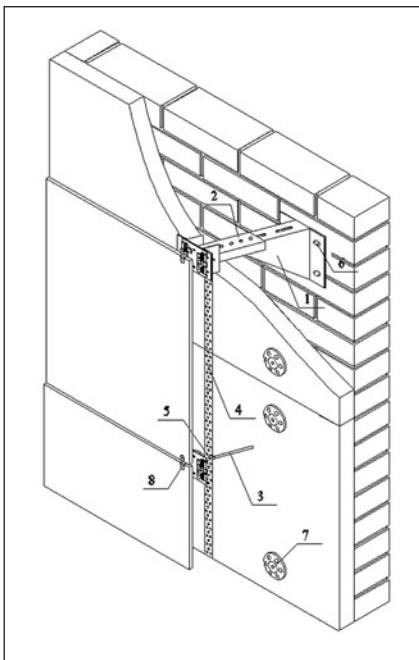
Узлы крепления ФСВЗ к стенам зданий
